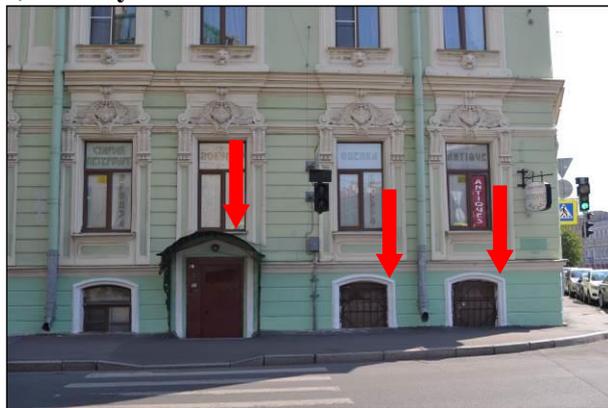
Вход в парадную (слева) и два окна помещения, выходящие на Почтамтский переулок
